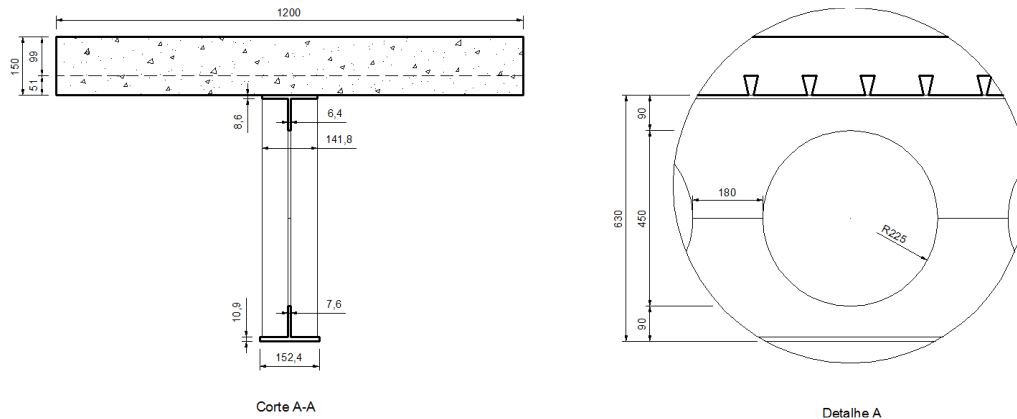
Características geométricas da viga Beam_1B (dimensões em milímetros).
